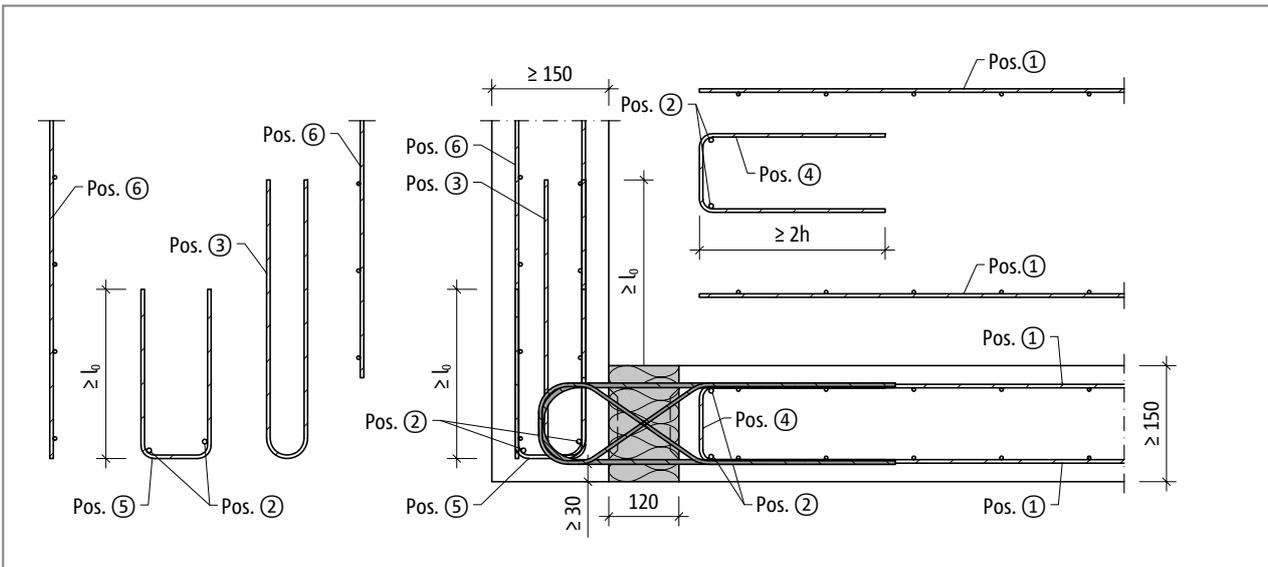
Schöck Isokorb® Typ ABXT horizontale Anordnung: Bauseitige Bewehrung
